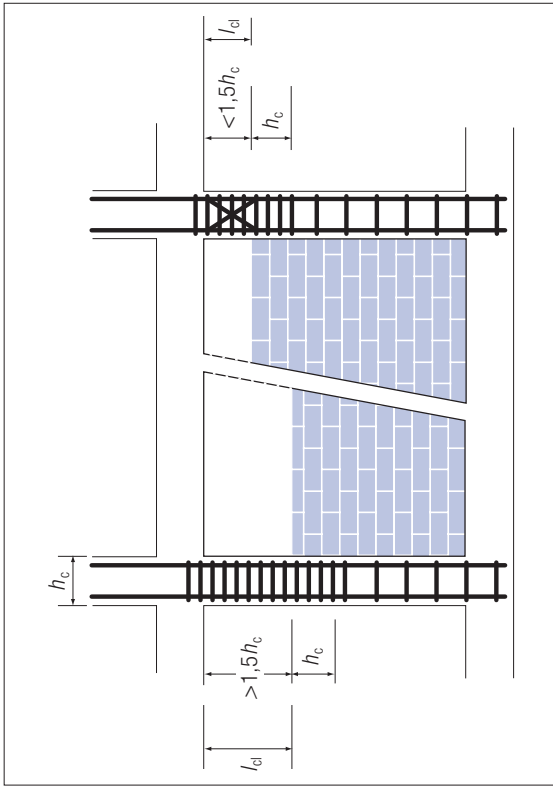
Remplissage partiel en maçonnerie – disposition des armatures d'effort tranchant dans les poteaux
